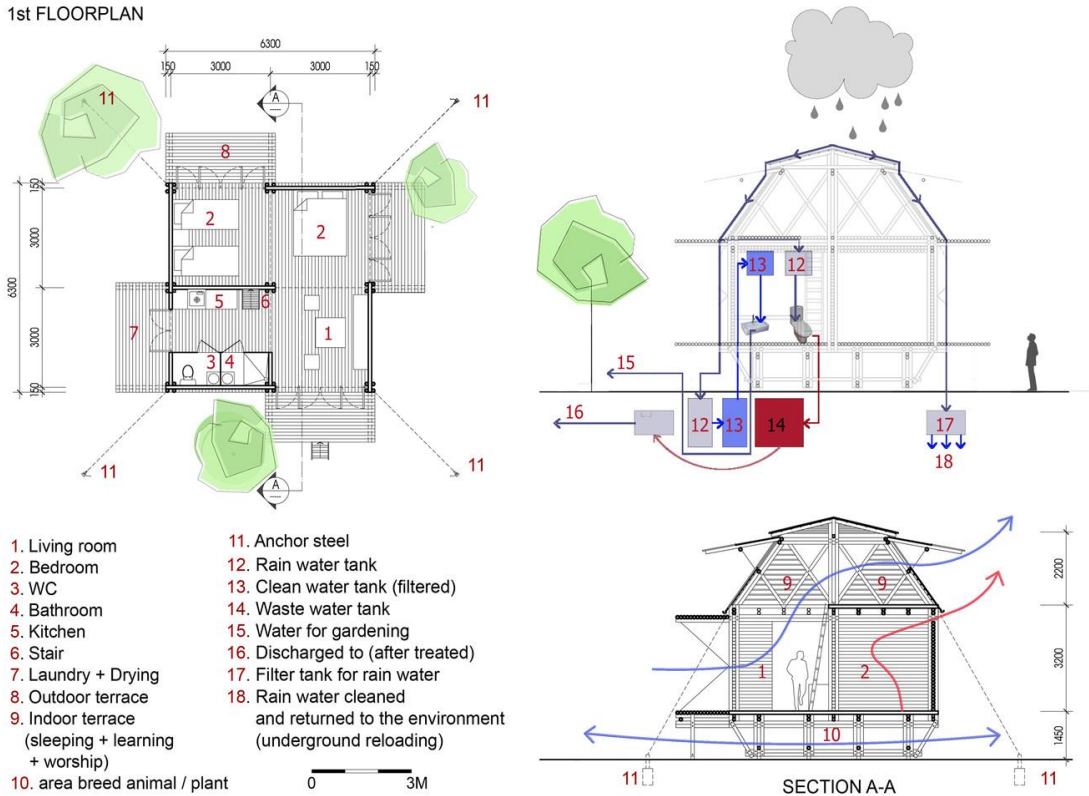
Planos de la Casa Bd. Fuente: Archdaily,2013.
